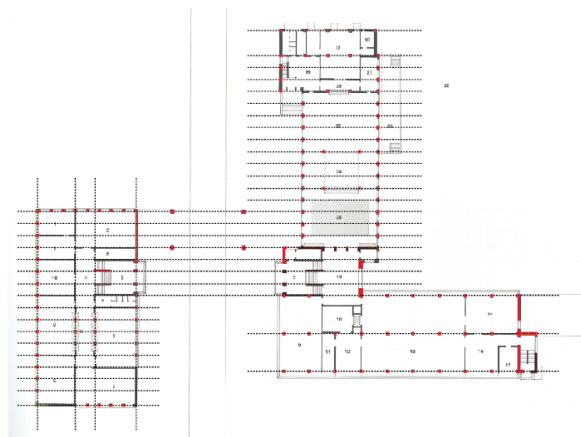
Esquema Estructura Bauhaus (hecho por autor)
